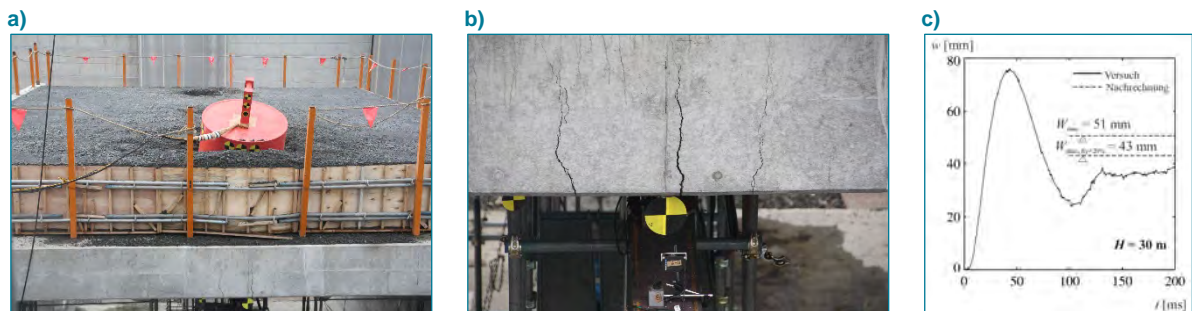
Letzter Fallversuch auf Kiesüberdeckung mit Fallmasse 15 t und Fallhöhe 30 m; a) Eingedrungener Fallkörper, b) Risse in der Galeriedecke, c) Durchbiegung im Zeitverlauf
